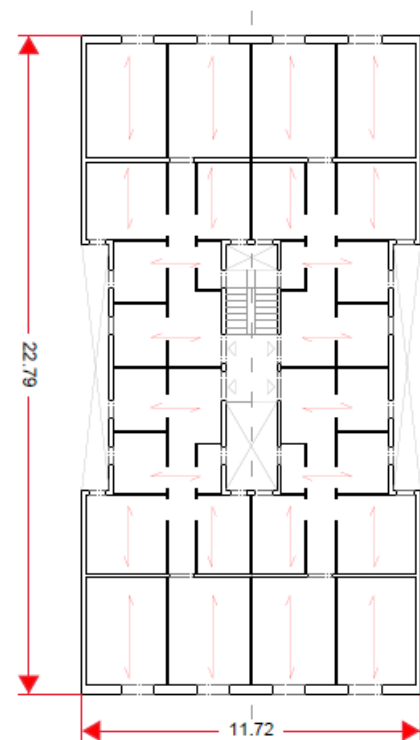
Plano estructural de la distribución en planta del edificio de la calle de Calàbria 207 extraído de Cornadó (2015)
